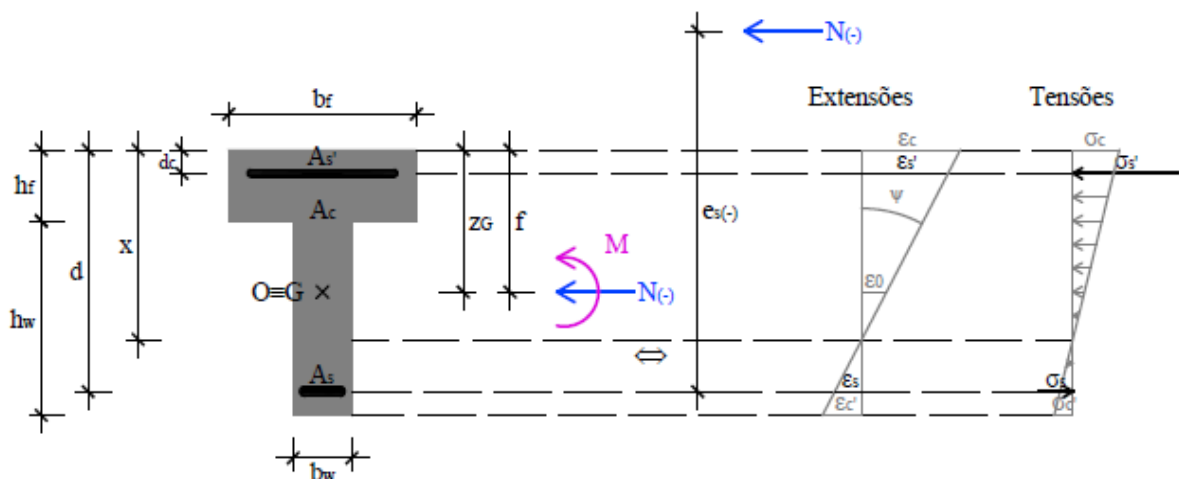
Distribuição de extensões e tensões numa secção não fissurada
